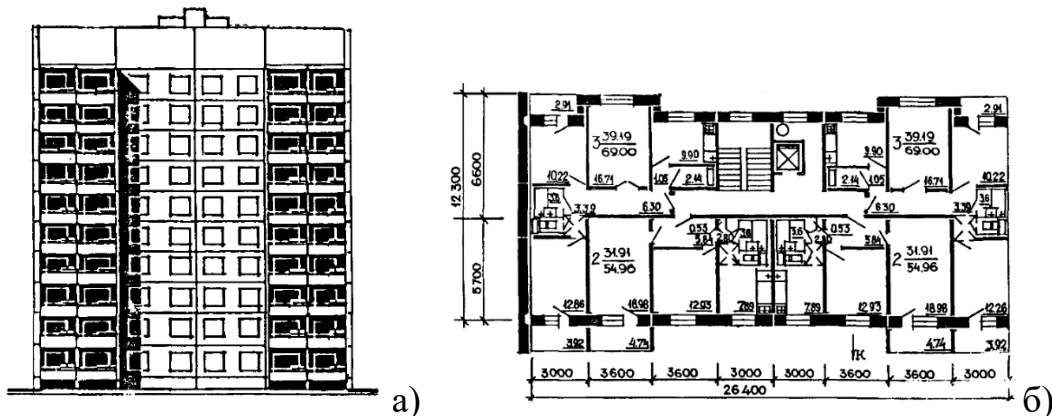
Фасад (а) та план типового поверху (б) будинку
